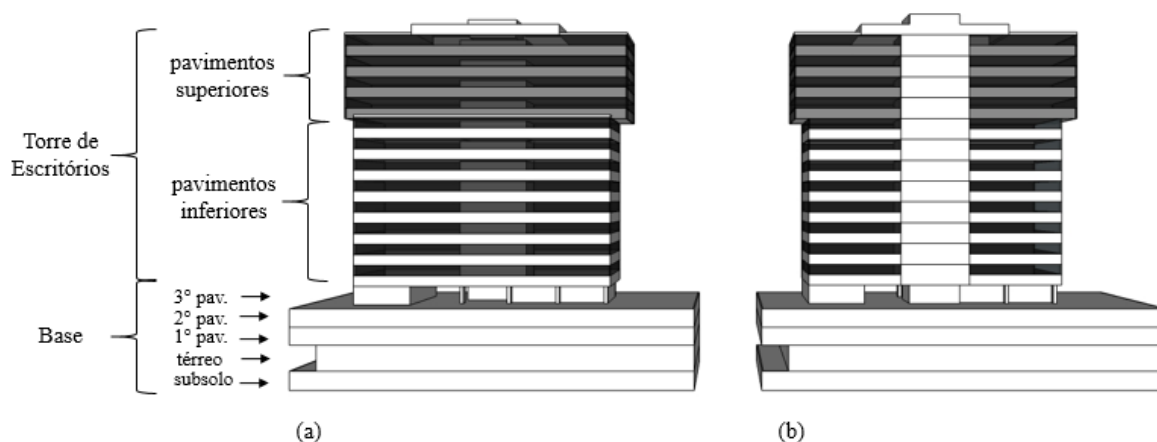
(a) Perspectiva da fachada norte e (b) perspectiva da fachada sul do edifício X
